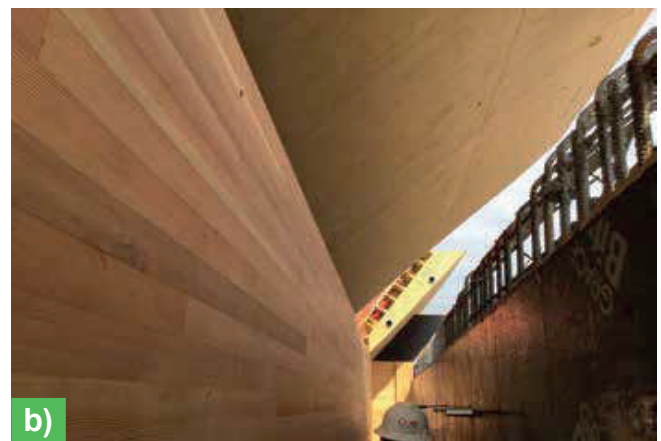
La pared curva “característica” del “Skylight Pavilion” requería un sistema de encofrado extremadamente complejo: (a) las torres de encofrado iniciales sobre el sitio, adyacentes a la grúa torre (b) el acabado de la tabla machihembrada fue especialmente desafiante de crear en la superficie curva; (c) se requería un espaciado uniforme de los tirantes; y (d) la escala del muro se aclara con esta foto del equipo que conmemora la colocación final del concreto del muro.
